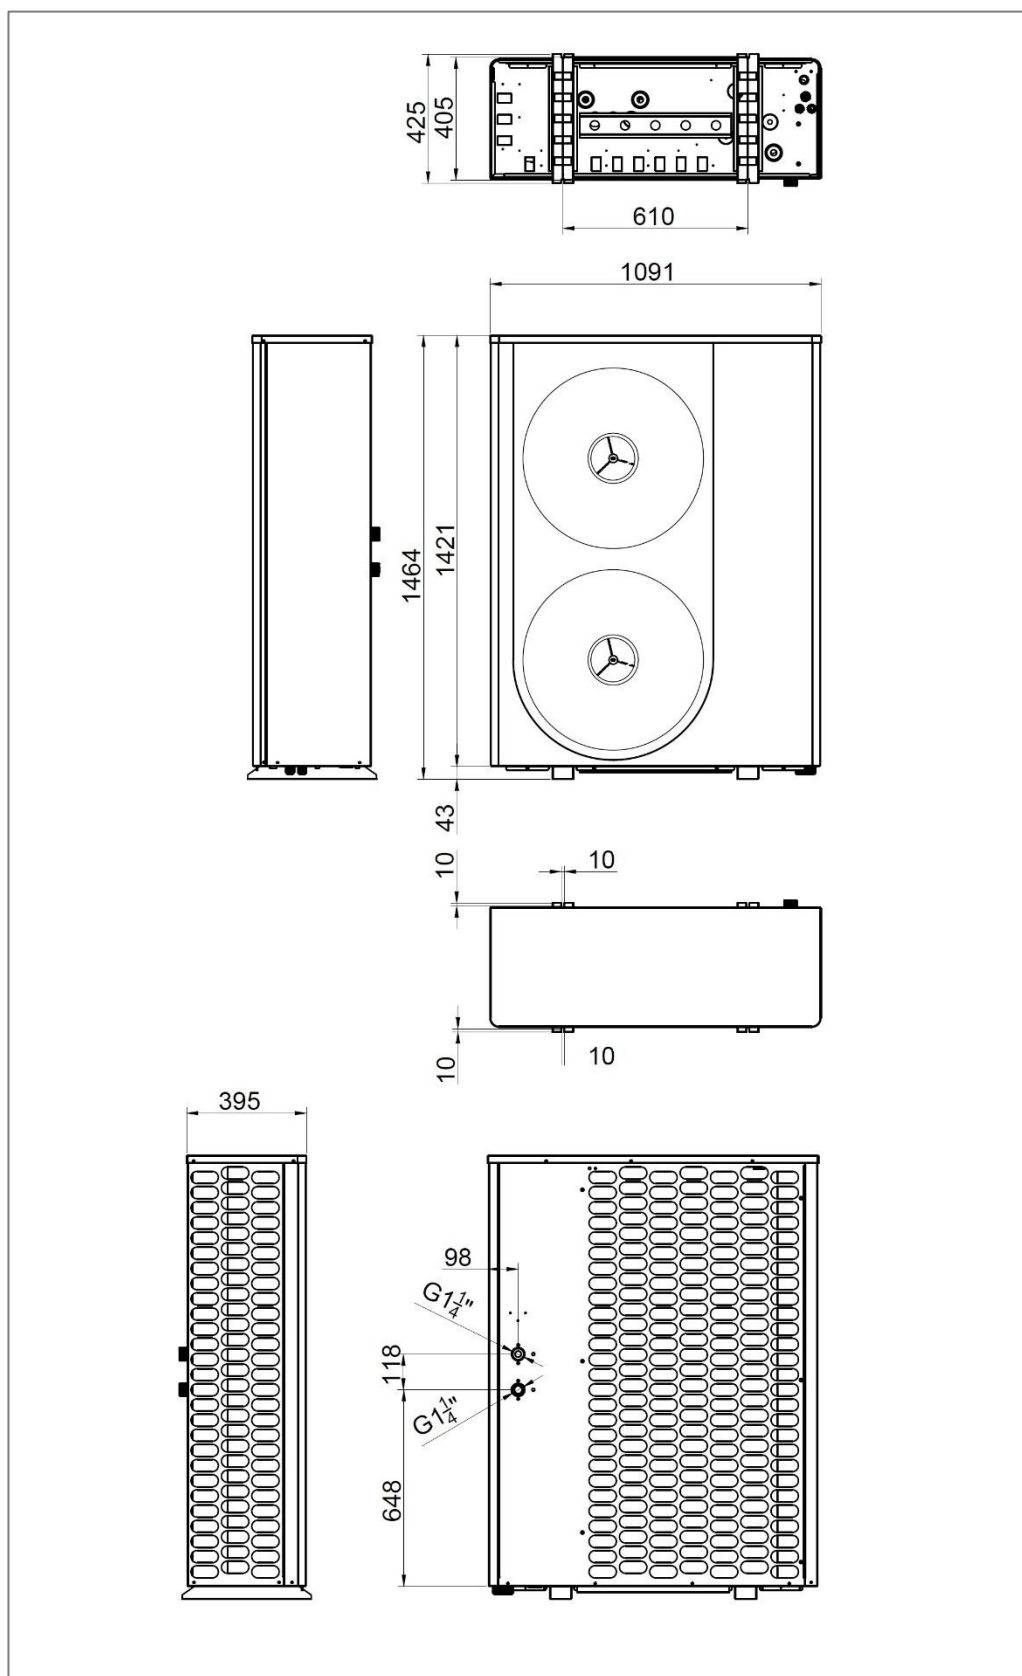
Dimensions de l'unité extérieure MB700015A - Dimensions en mm
